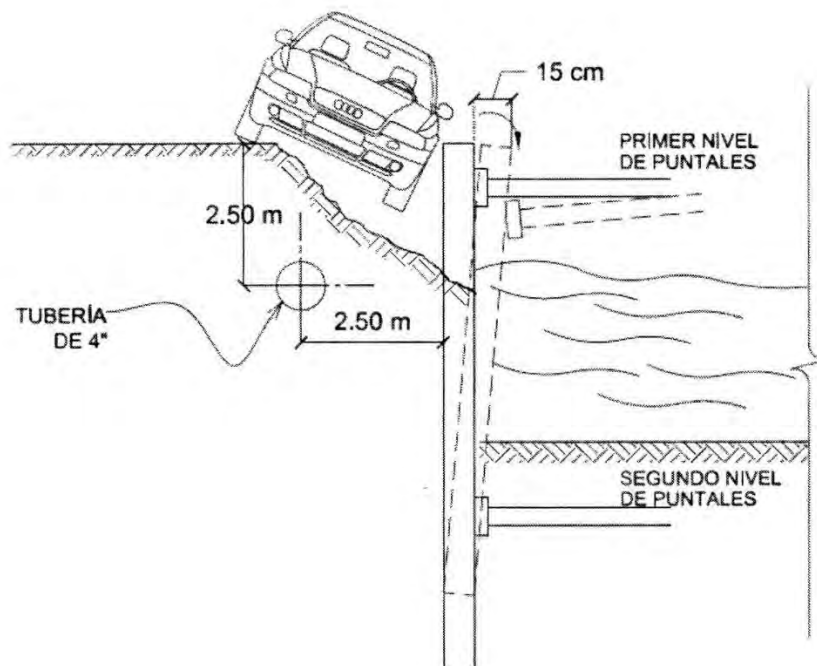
Desplazamiento del muro tipo Milán, dislocamiento de la tubería de agua potable y volcadura del vehículo.
